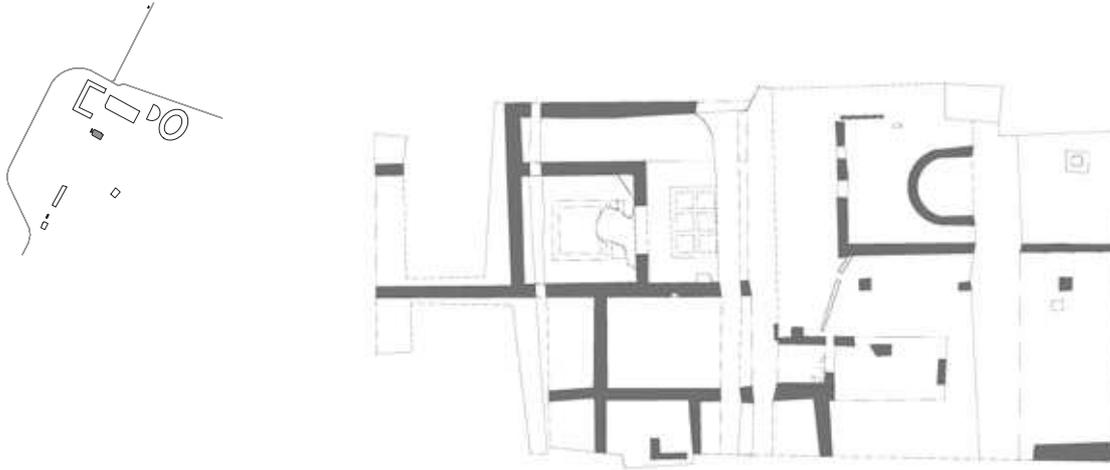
Planimetria con reperti rinvenuti dell' Edificio Oceano.
